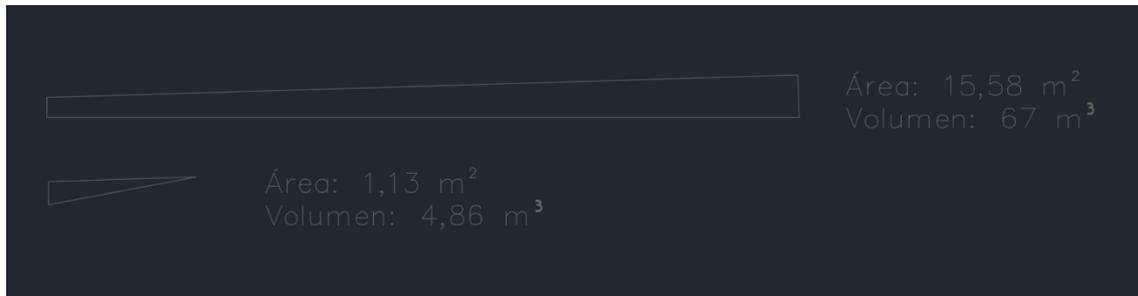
Volumen de excavación a realizar obra drenaje P.K. 5+895
